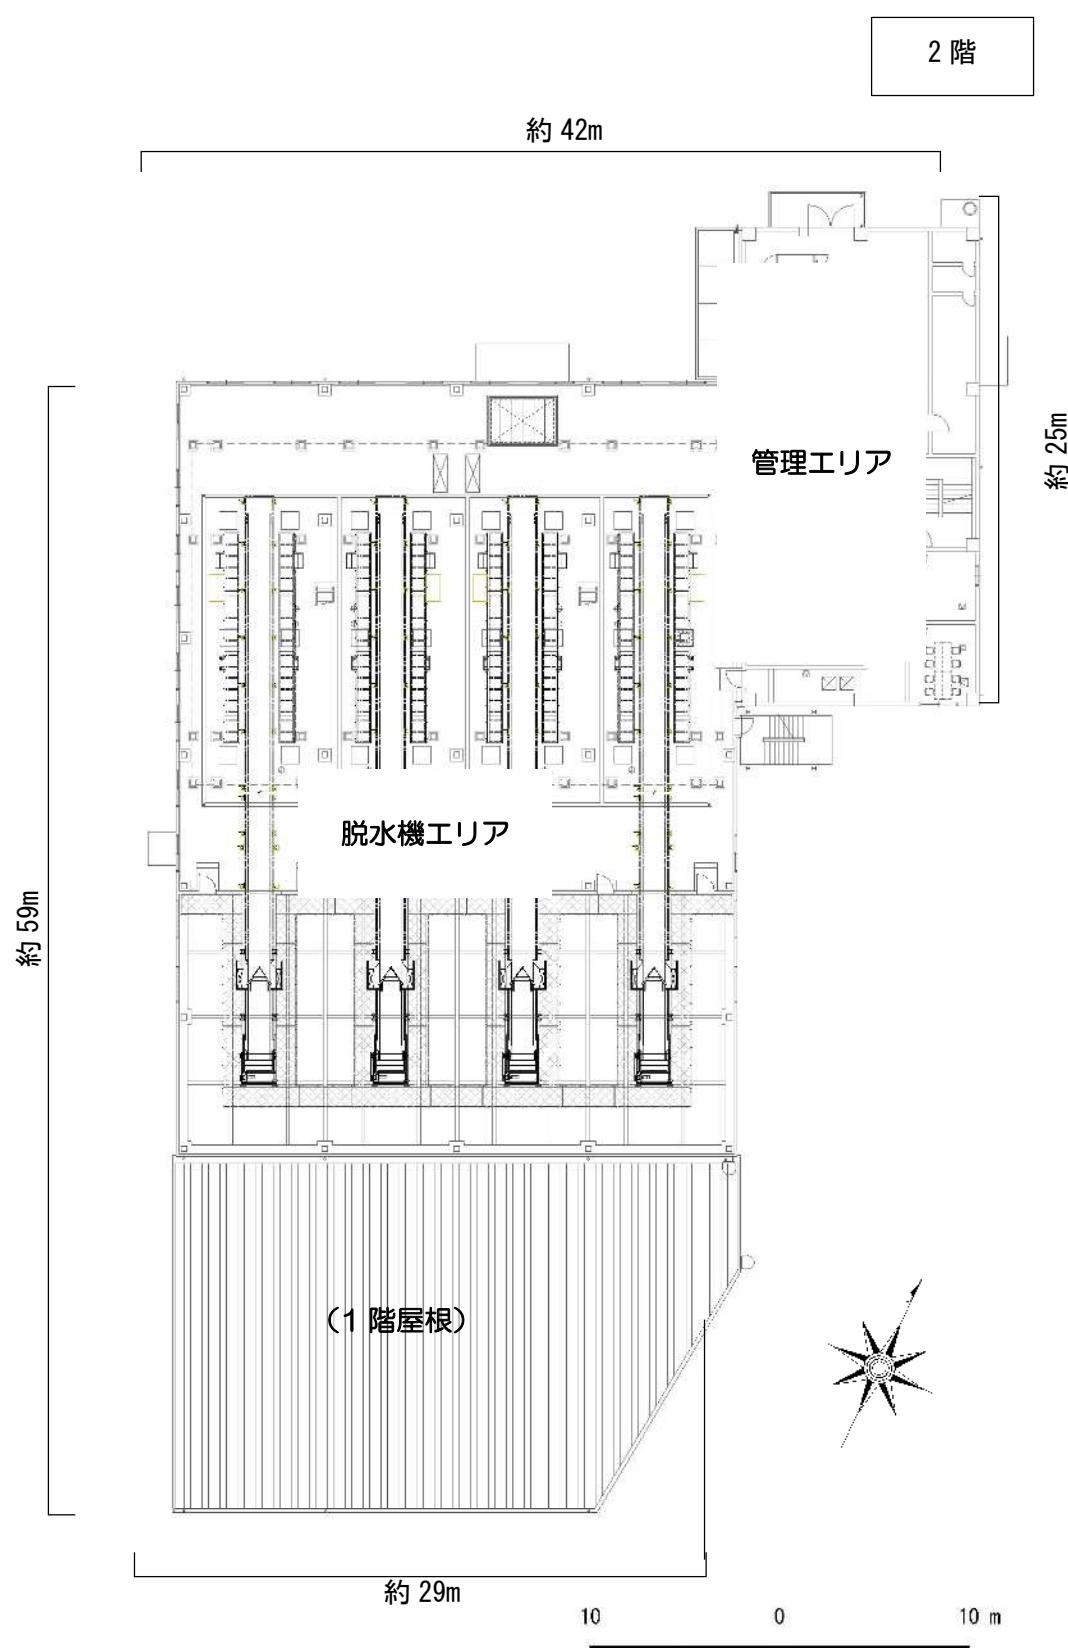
(2) 2 階平面図 (縮尺 1:400)
